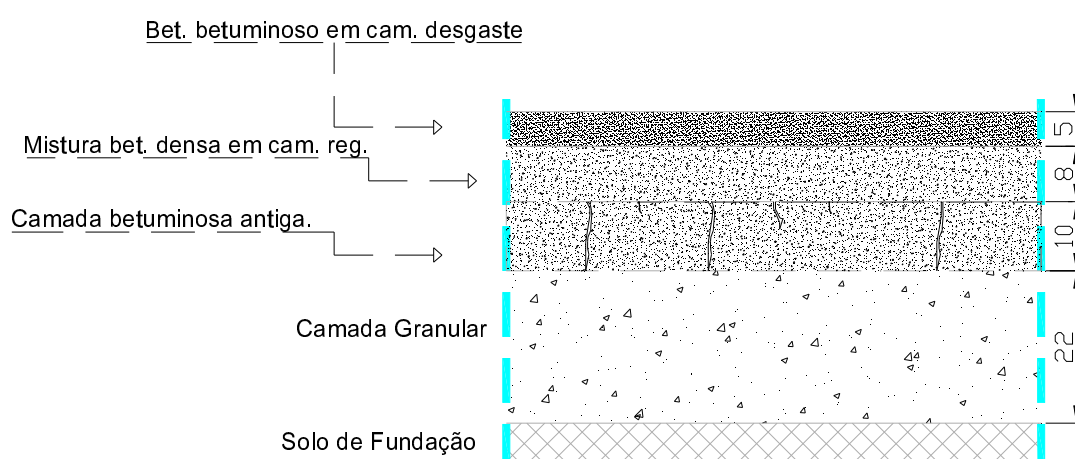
Estrutura do pavimento da Rua Cónego Dr. Manuel Faria para a alternativa de reforço
